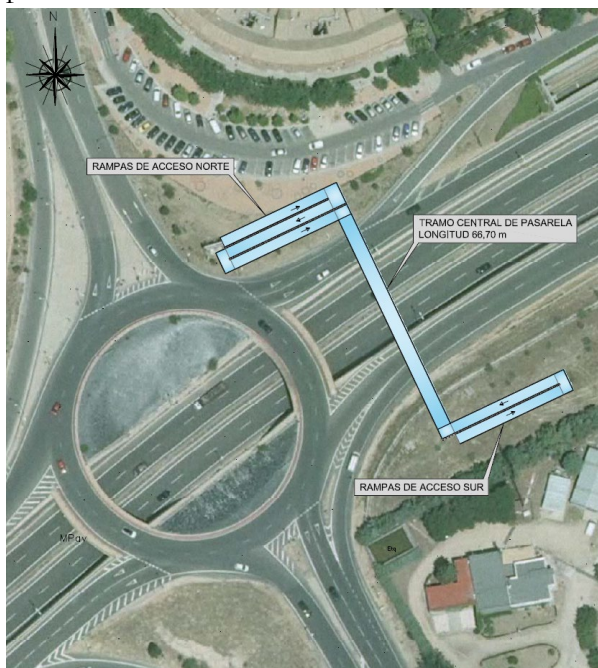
Planta de ubicación de la pasarela en el enlace en la M-503
